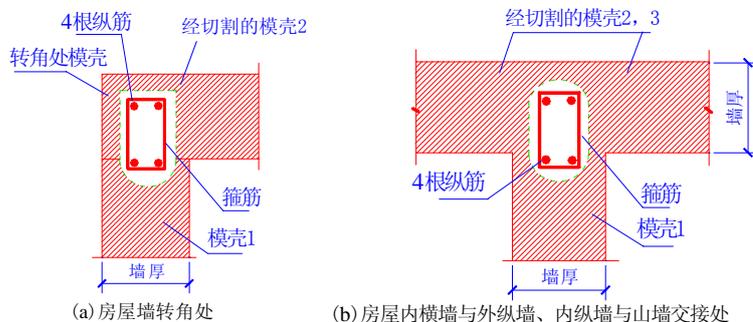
房屋墙体连接处构造边缘构件的配筋
